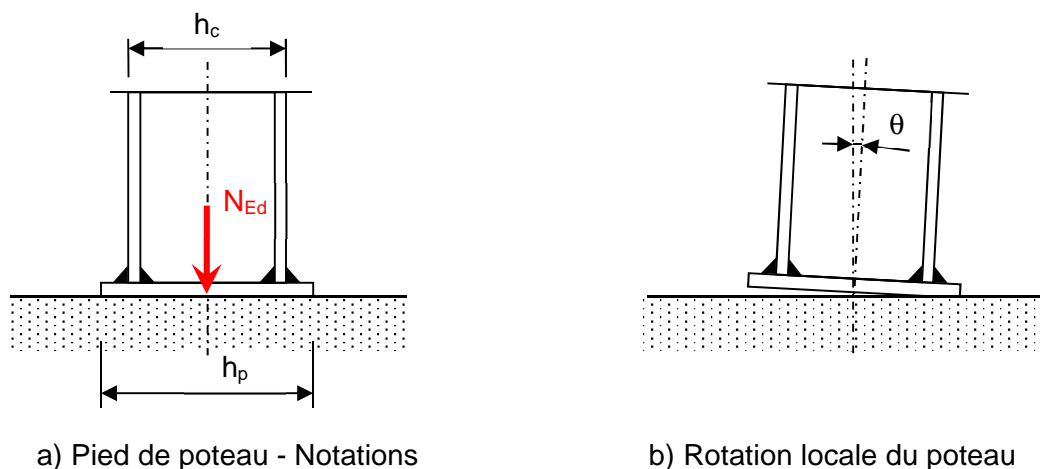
Pied de poteau articulé avec platine d'extrémité (bêche non représentée).
